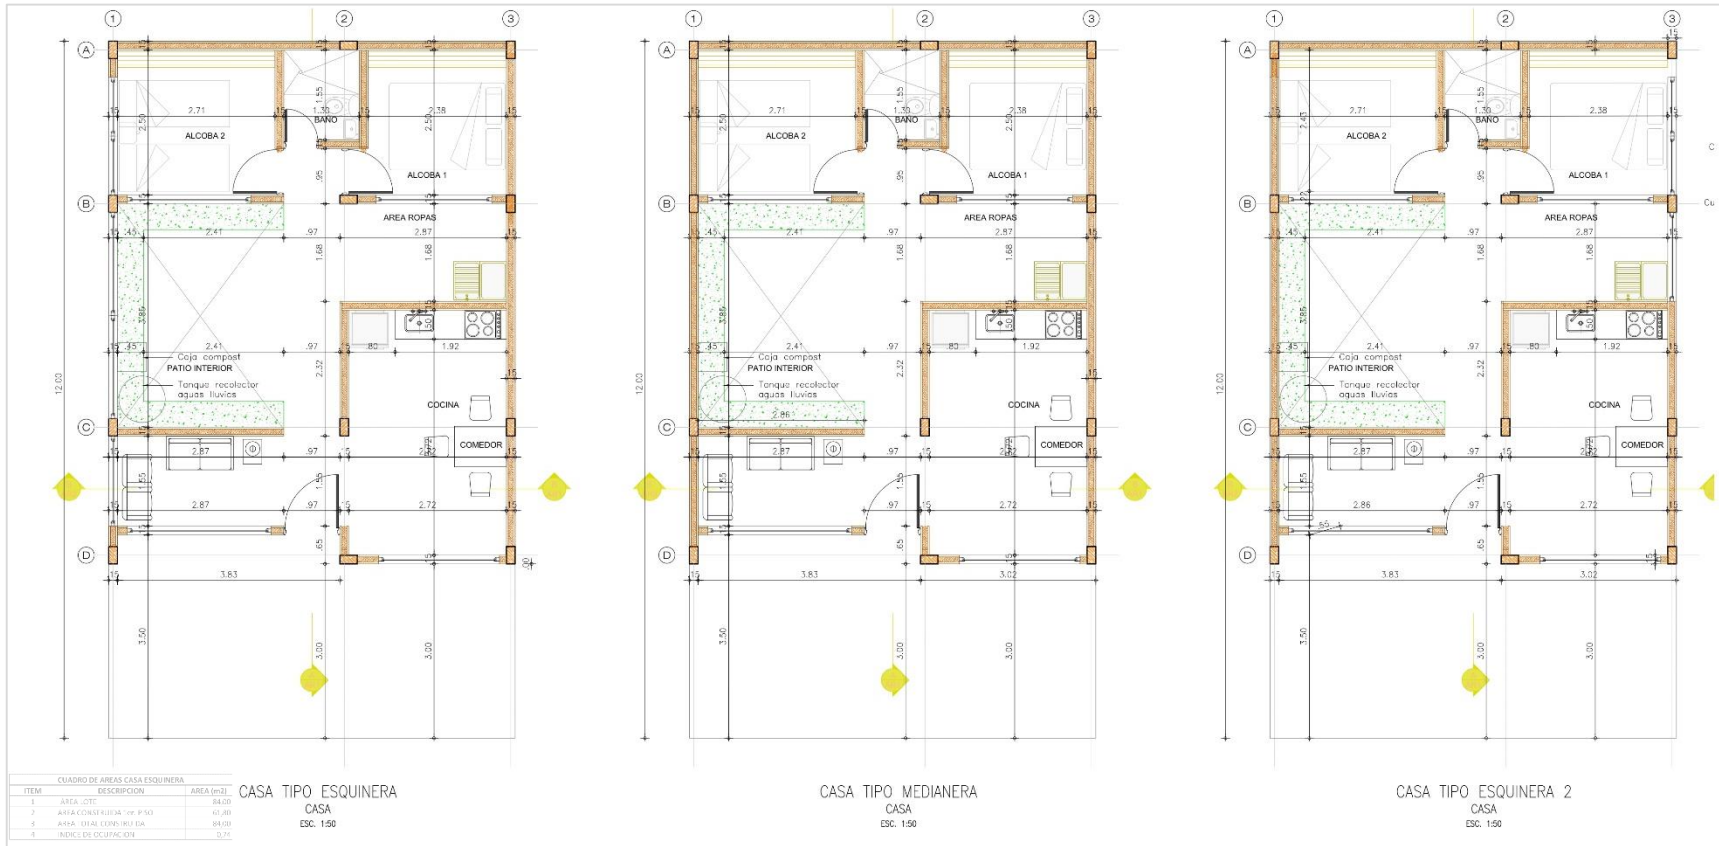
Plano Arquitectónico vivienda sostenible. Fuente: Propia
